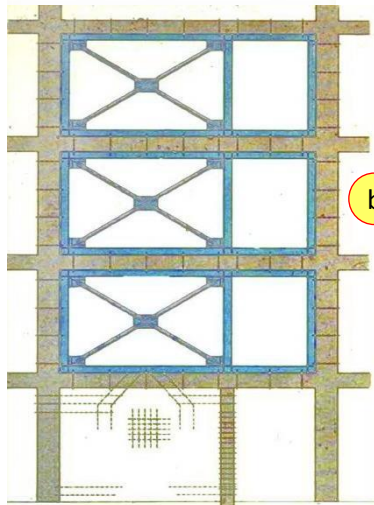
Structură de beton armat la o clădire din Mexico City
